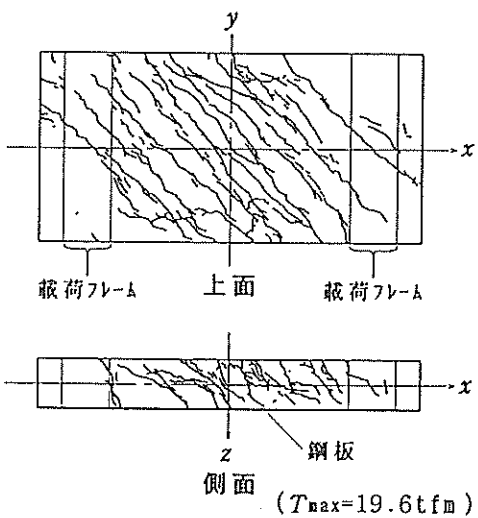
供試体 OS-16-100のひび割れ発生位置
